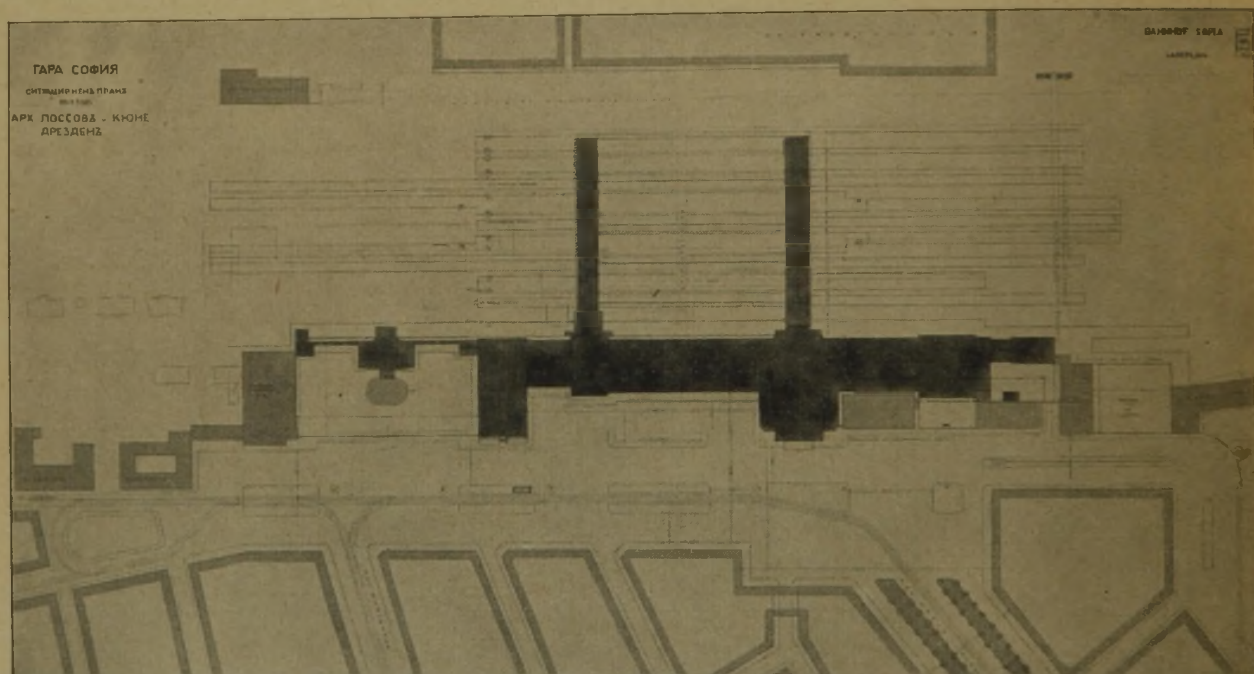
Lageplan mit Übersicht der Gesamtanlage. (1 : 400.)
